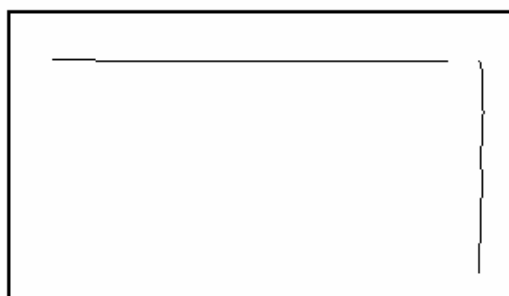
Fisura en estucos sin refuerzo de fibra de vidrio
